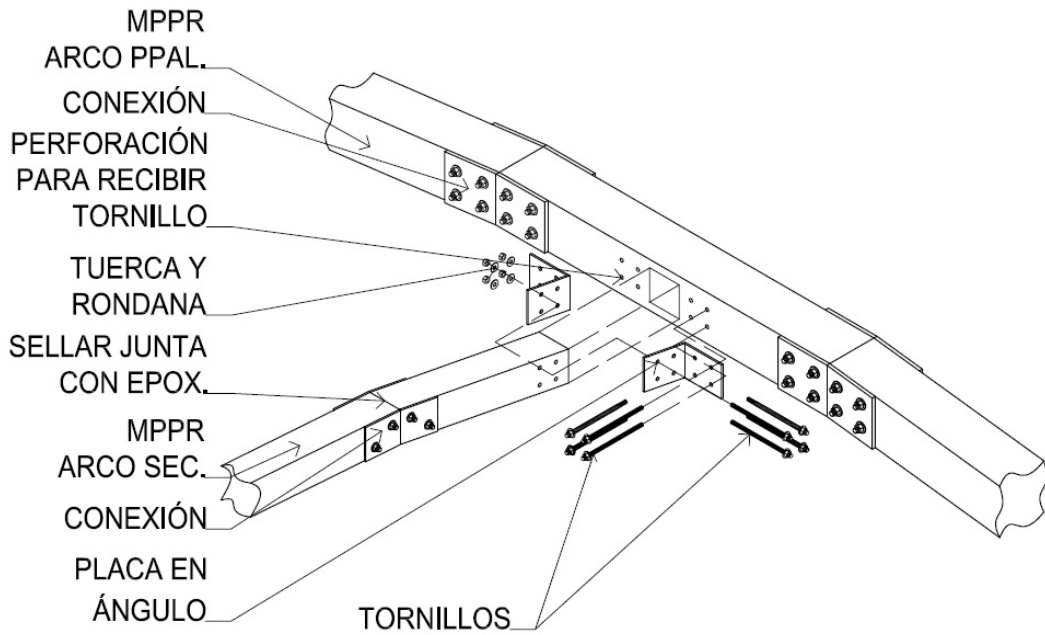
Detalle de conexión entre arco secundario y principal. Vista isométrico.
